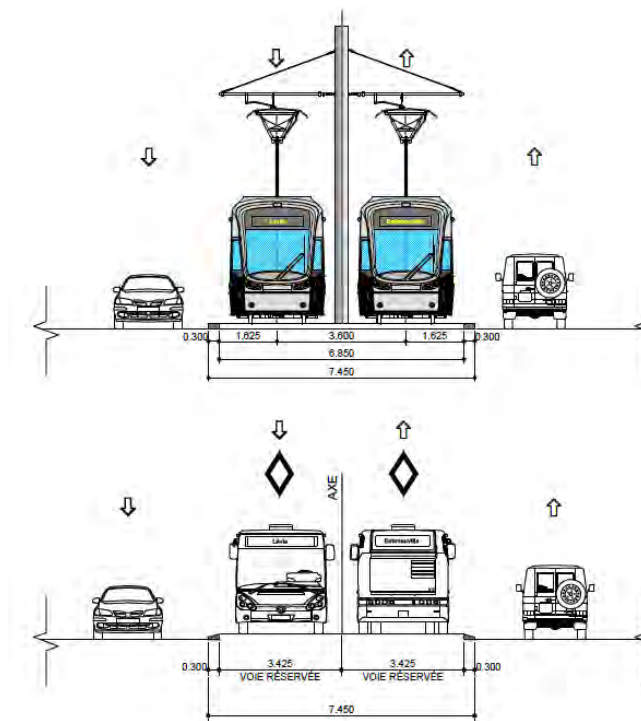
Coupe 03 de 15 - SRB - Site espace restreint - Insertion axiale semi-franchissable
